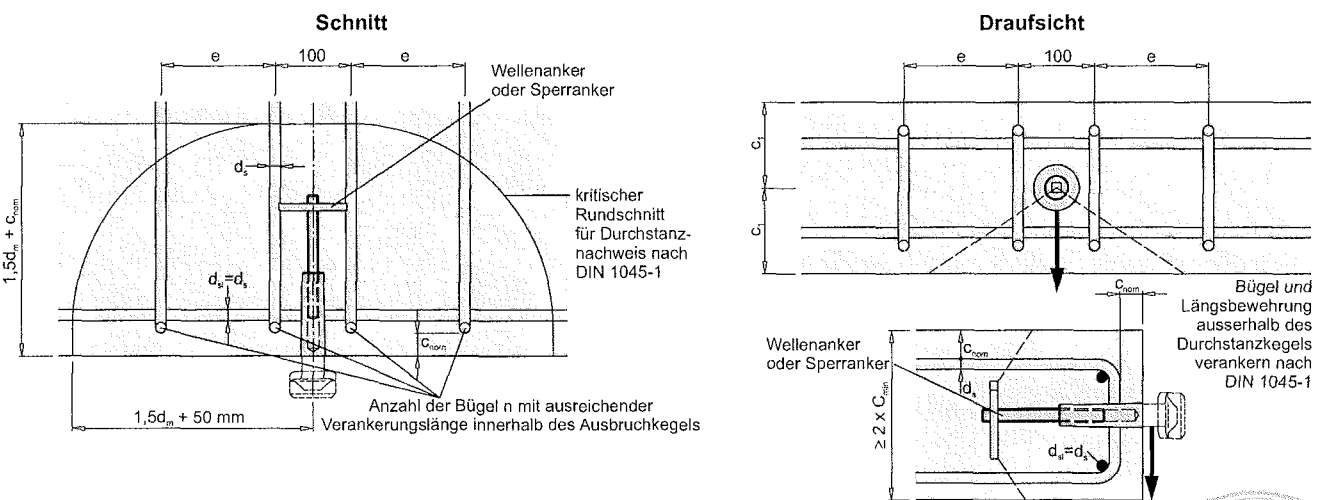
Einbausituation Stirnseite - Querbeanspruchung mit Rückhängebewehrung - Bewehrungslage
